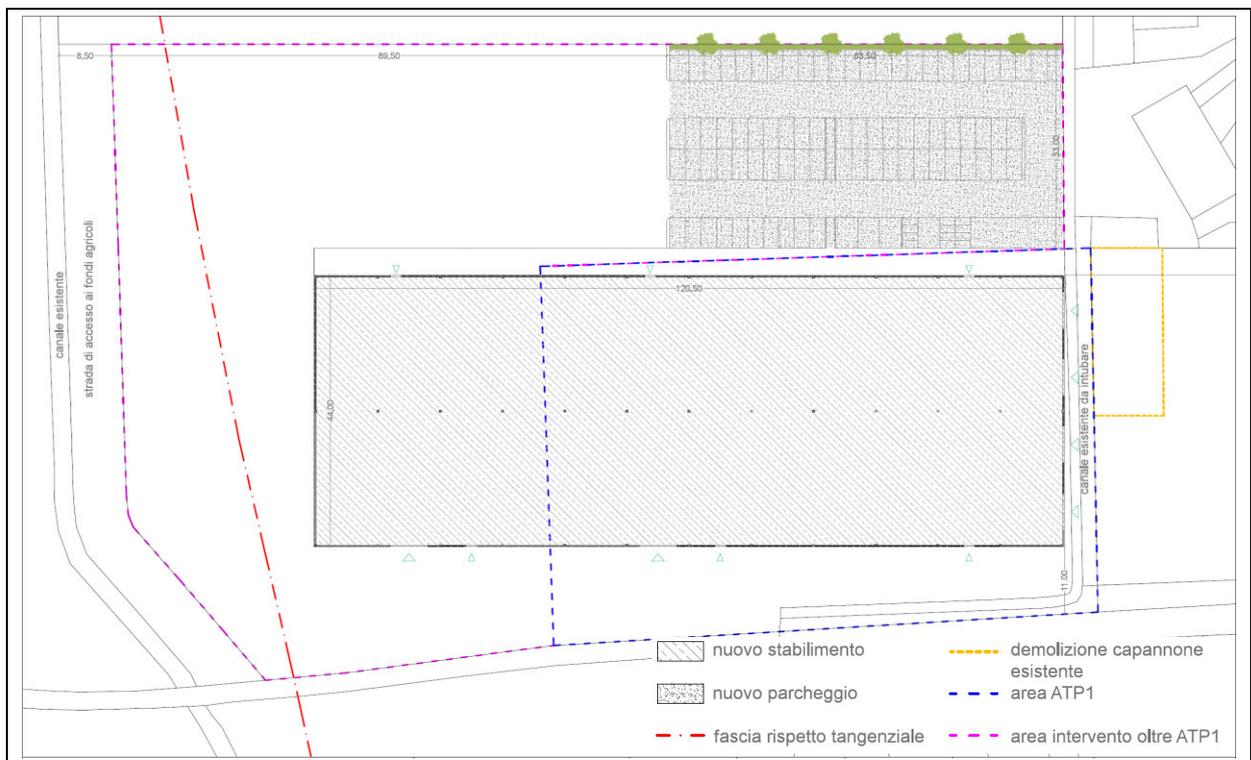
SUAP in Variante: planimetria di progetto (fuori scala).
